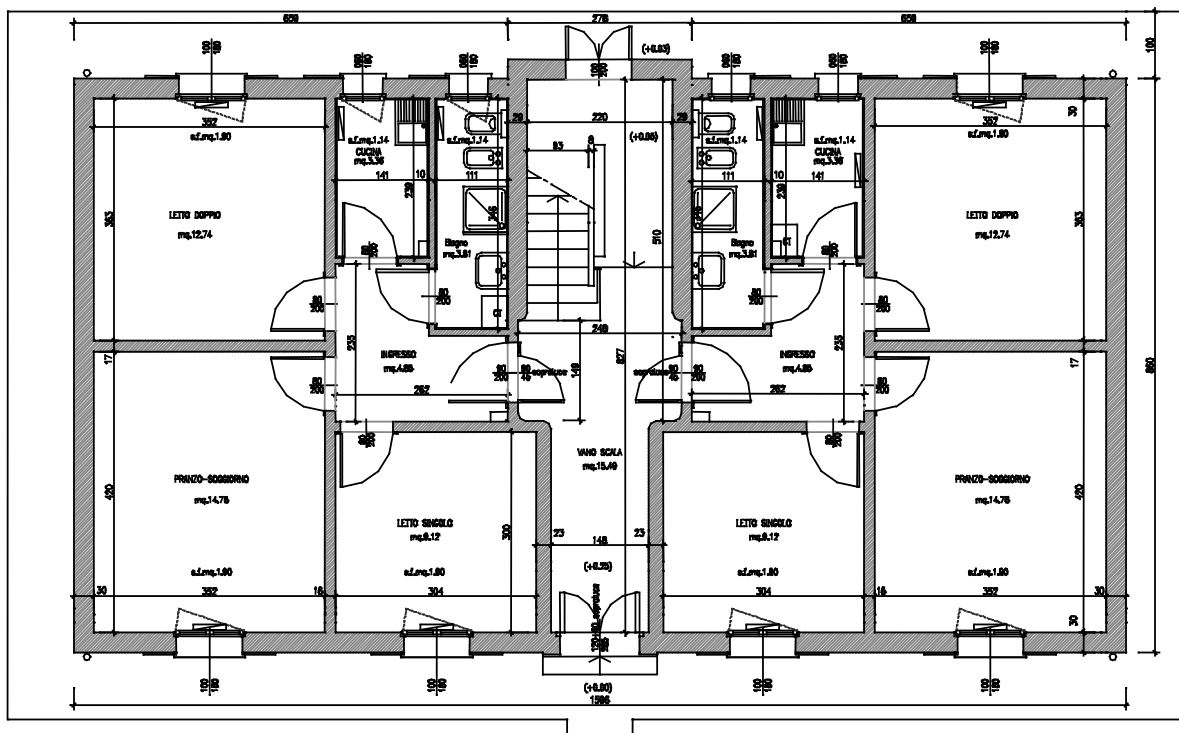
PALAZZINA TIPO B: Pianta Piano Terra – Stato di Fatto
